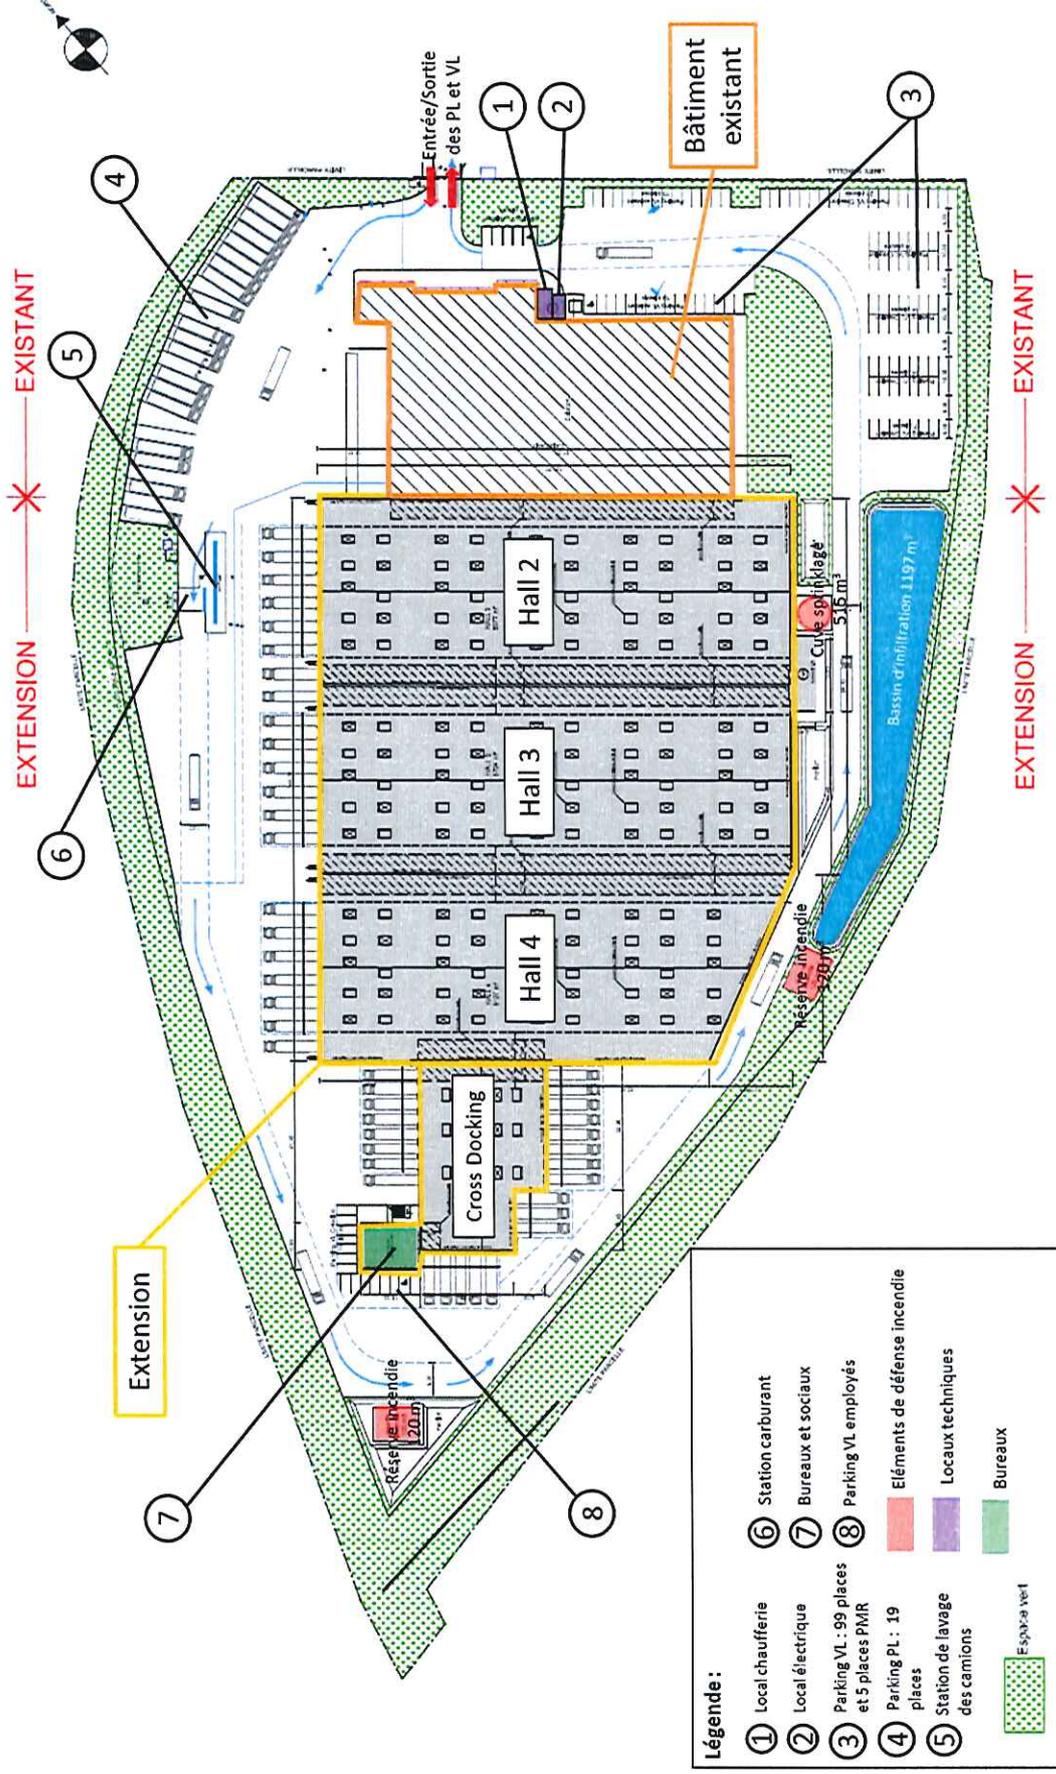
Plan de masse de l'entrepôt avec extension – Source : Lahat-architectes
